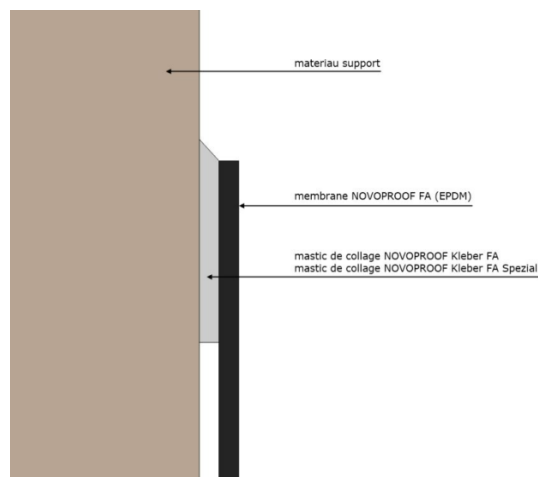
collage sur support avec Kleber FA et Kleber FA Spezial
